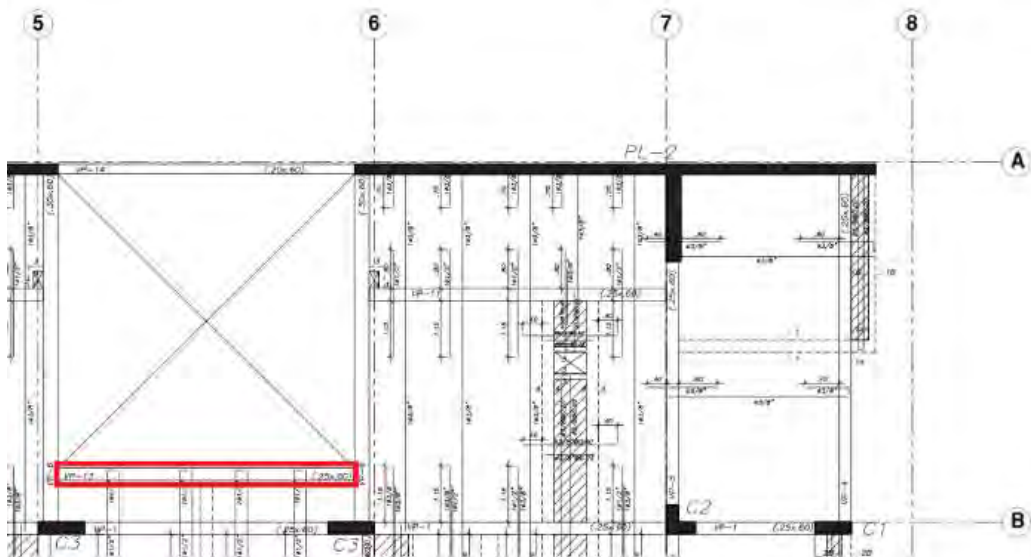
Viga VP-13 para ejemplo de metrado de cargas
